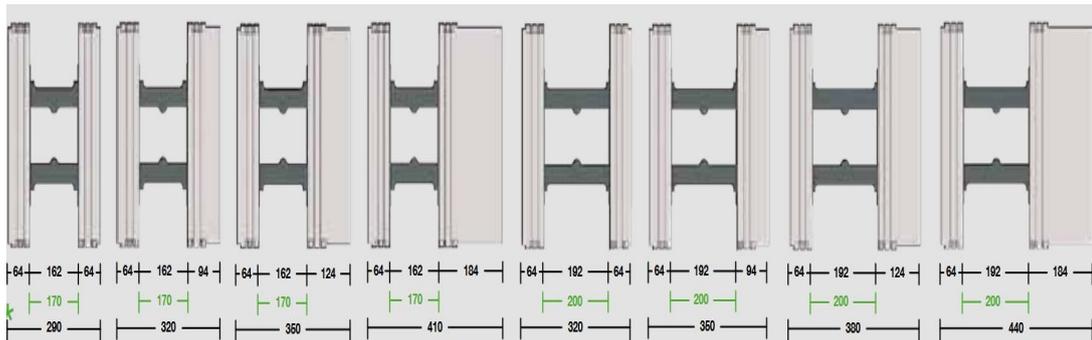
Prospetto frontale dei vari moduli impiegati durante l'esecuzione dei lavori.
